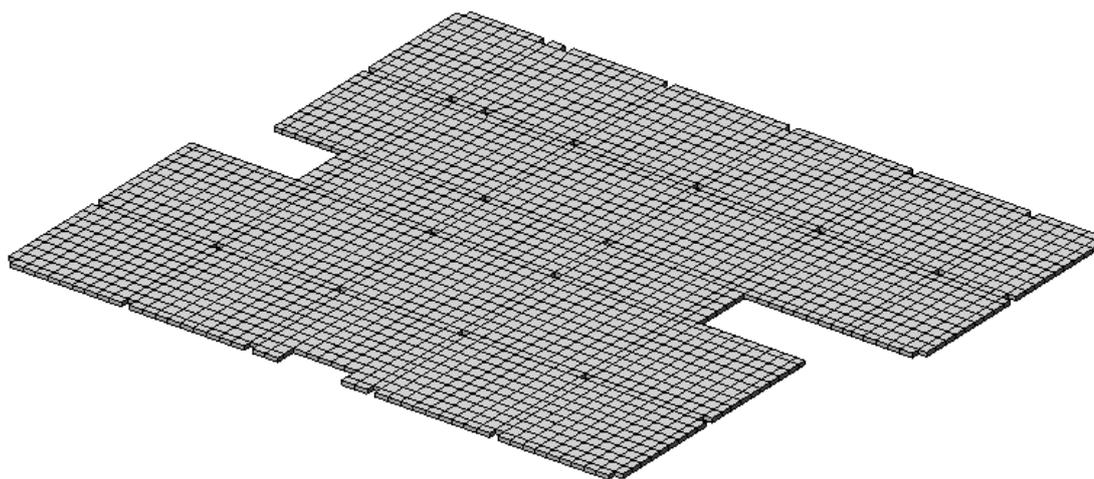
3D-вид плиты перекрытия ППМ-1
